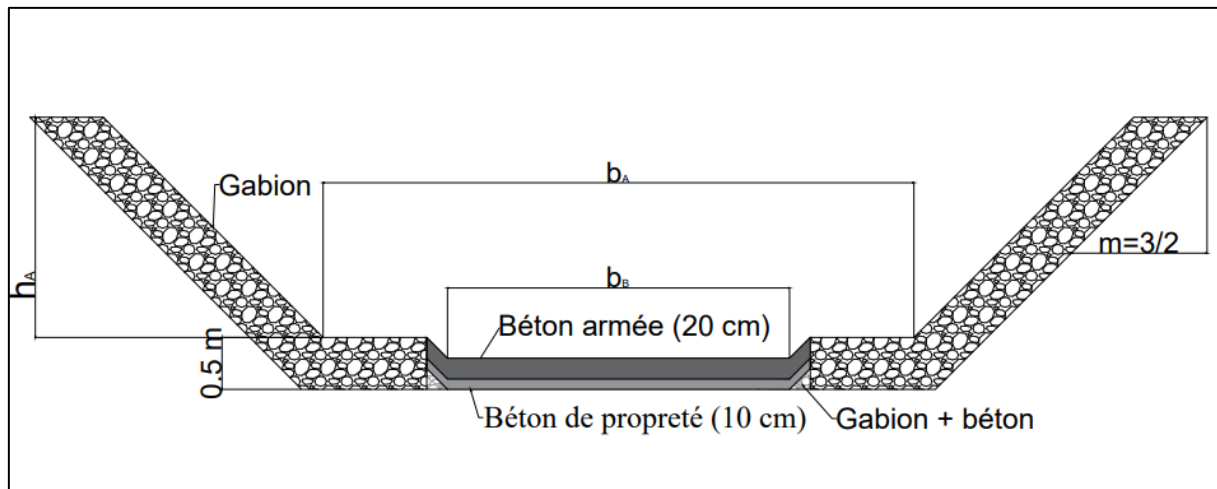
Coupe en travers d'un canal à section mixte (Gabion & béton).
